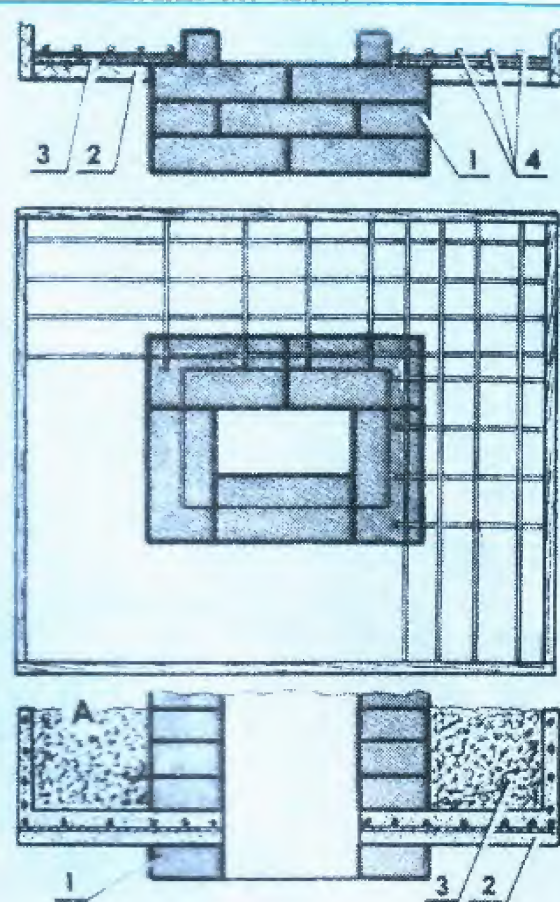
Формування плити видри із залізобетону: 1 — стояк труби; 2 — дерев'яна опалубка під розчин; 3 — глиняний шар; 4 — арматурні стрижні. А — видра із залізобетонного короба: 1 — стояк труби, 2 — короб; 3 — засипка (шлак, керамзит)
